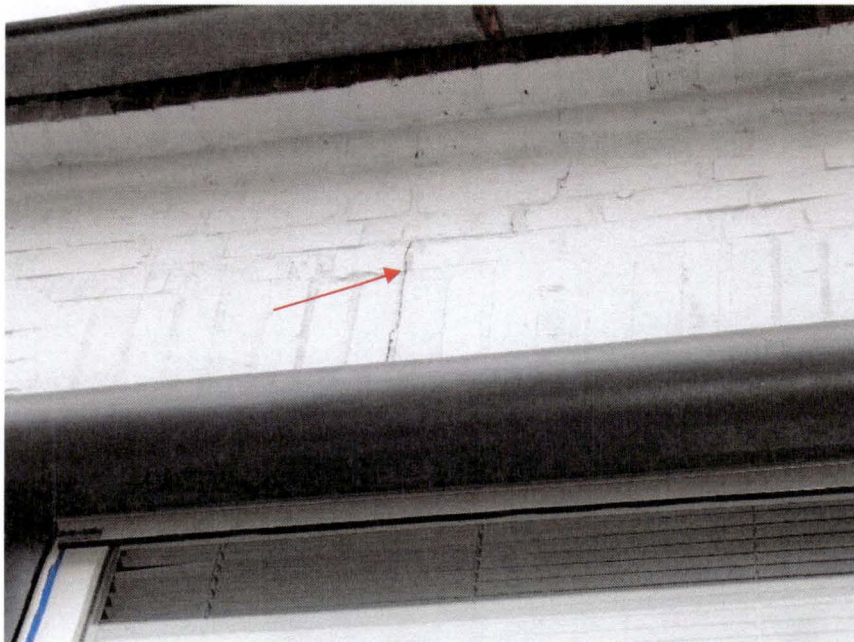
Wohnhaus Beispiel Rissbildung oberhalb des Wohnzimmerfensters
